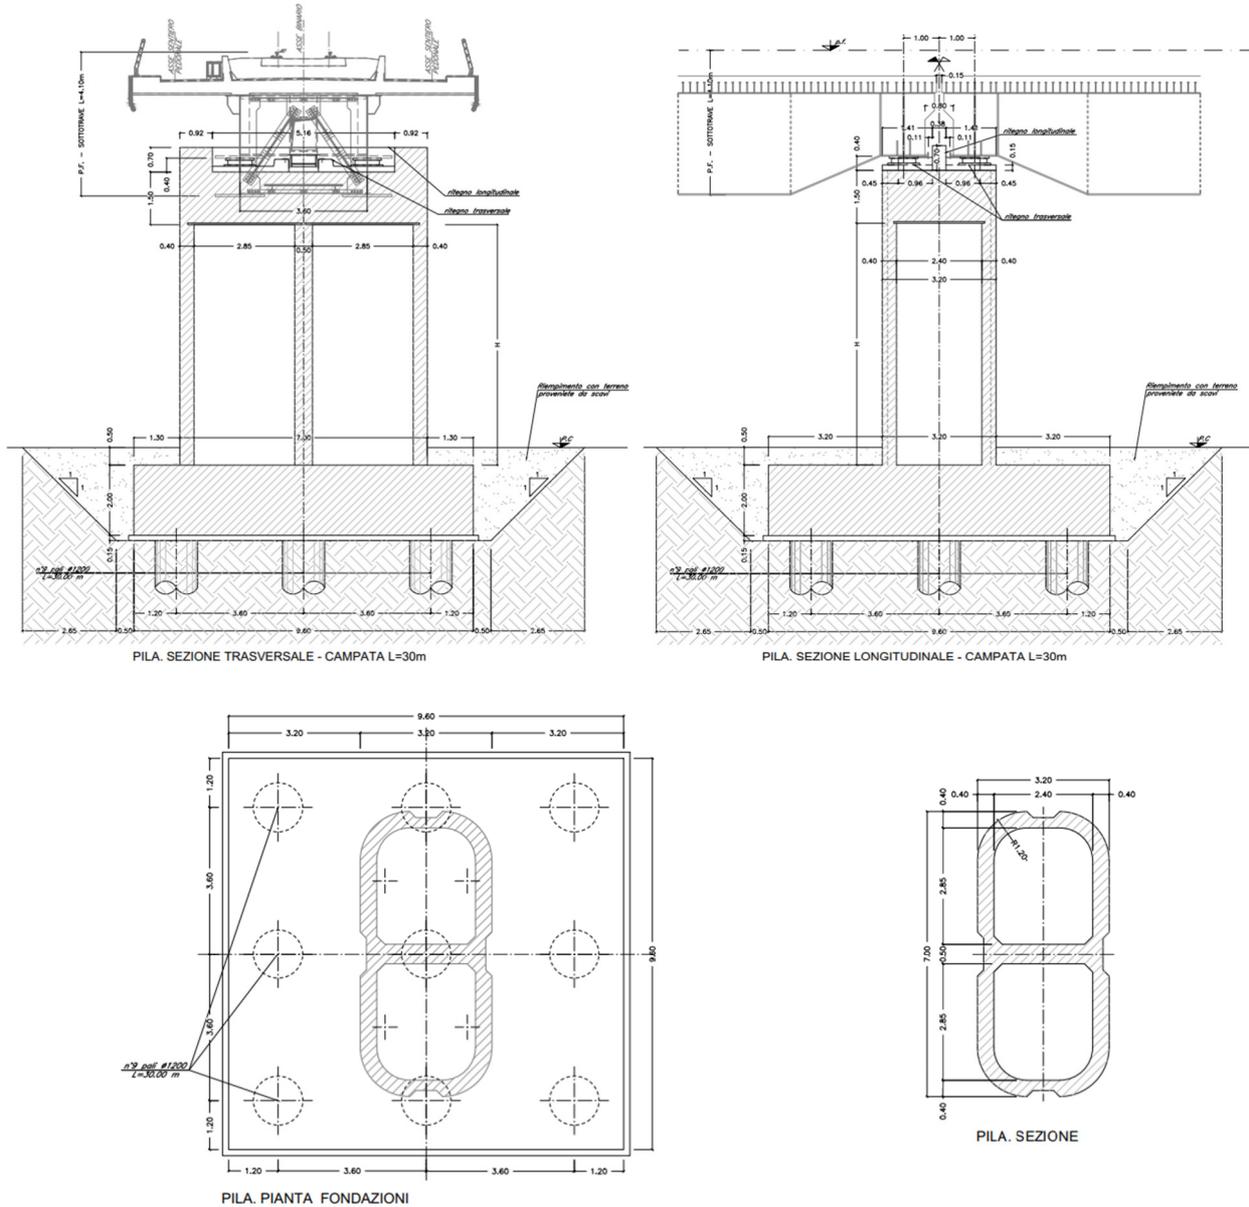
Geometria pile VI01 campate da 30 m. Dimensioni in m
